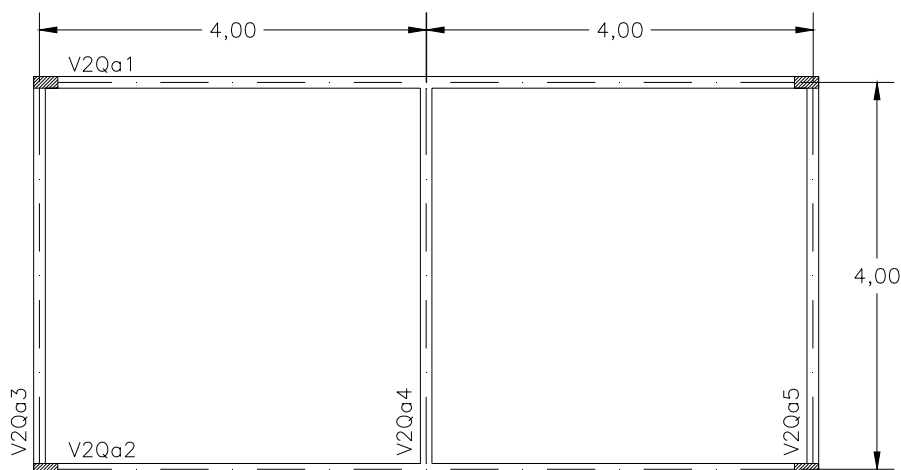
Pavimentos (P2Q) com dois painéis quadrados (4m X 4m) apoiados em 4 pilares
